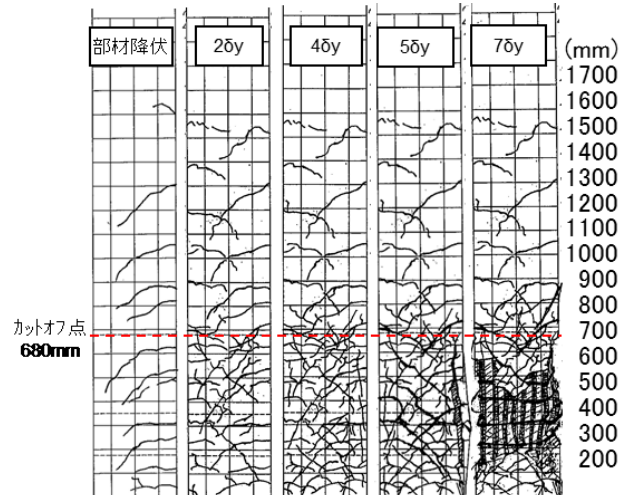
主な荷重ステップのひび割れ状況 (D-18)
